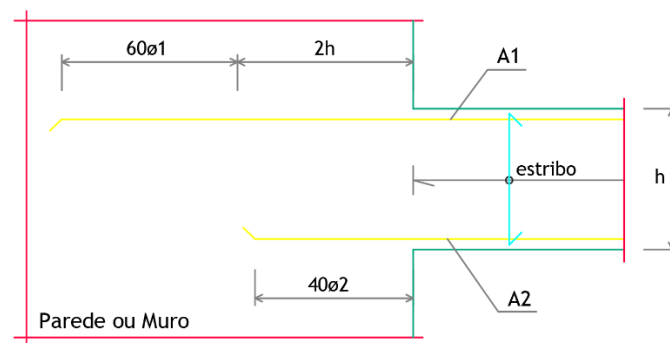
Amarração da armadura longitudinal junto a um apoio contínuo (Parede, Núcleo, Muro de Suporte, etc.) (Projeto de estruturas).
